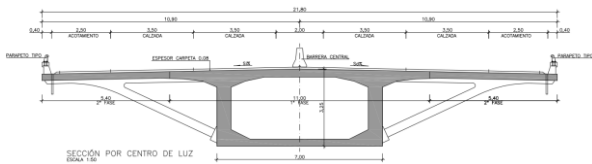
Sección transversal del Puente Las Truchas en el proyecto constructivo.
